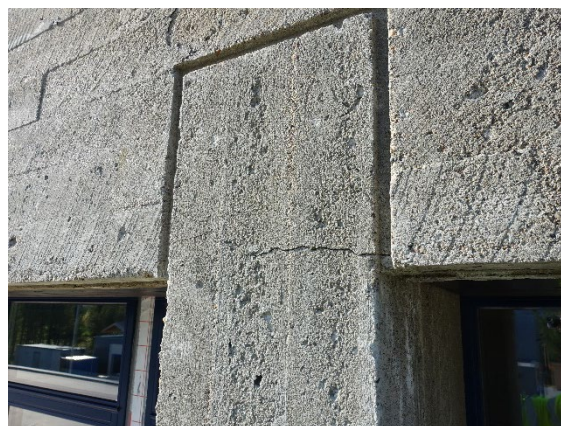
Pilar K5, armering registrert 20/12 mm bak oppsprekking.
